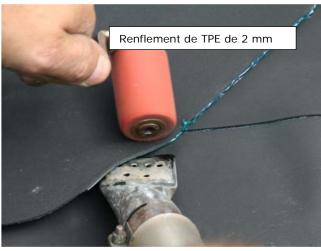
HERTALAN Easy Weld Recouvrement soudure vert sur noir
